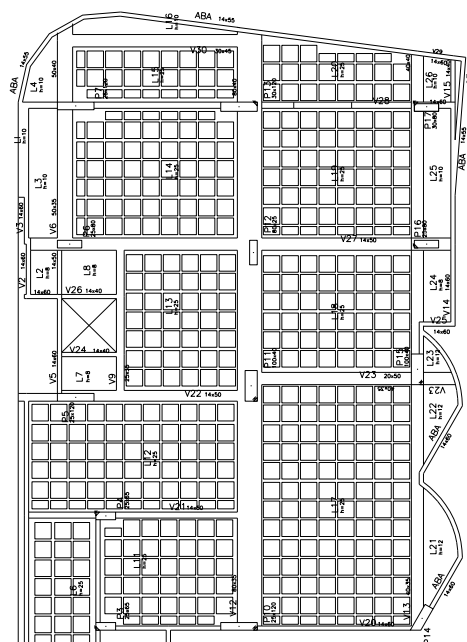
Edifício Mustique – Vigas faixas + Lajes nervuradas
